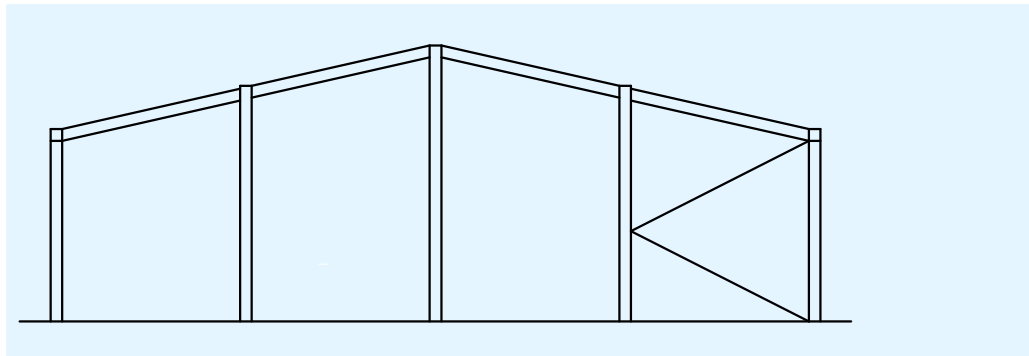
Estructura de cierre con pilares, vigas y arriostramiento
